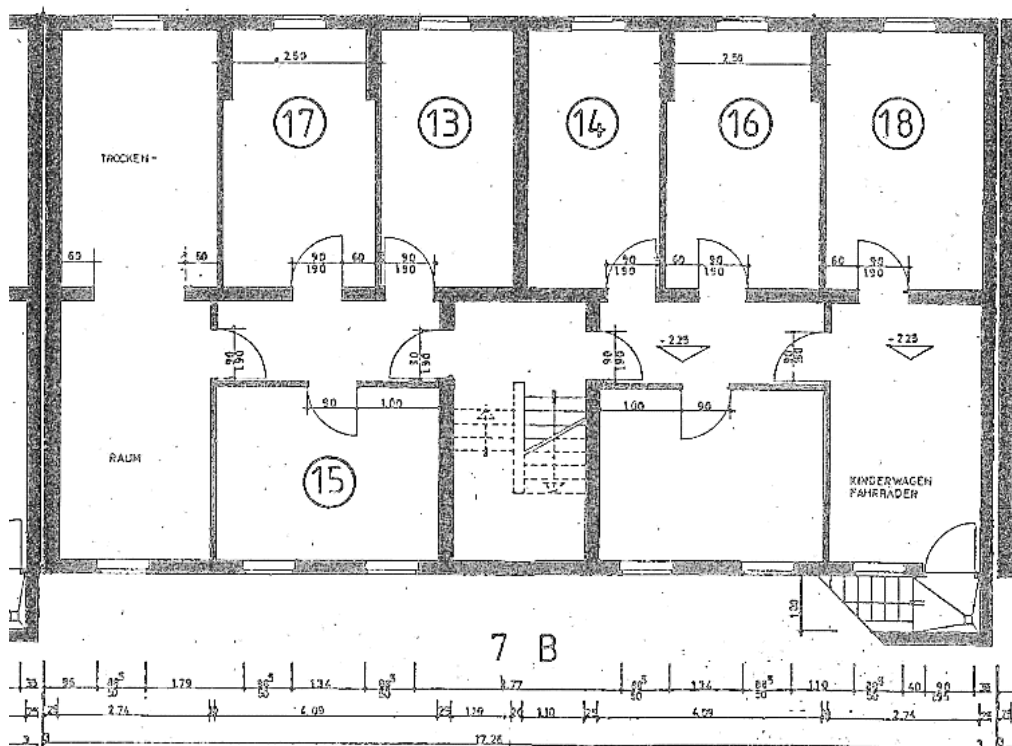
Grundriss Kellergeschoss (Teilungsplan)
